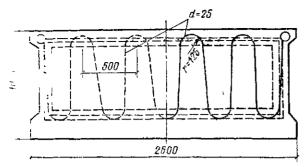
Варианты рассредоточенного размещения нагревательных элементов в бетонных стенах и перегородках
